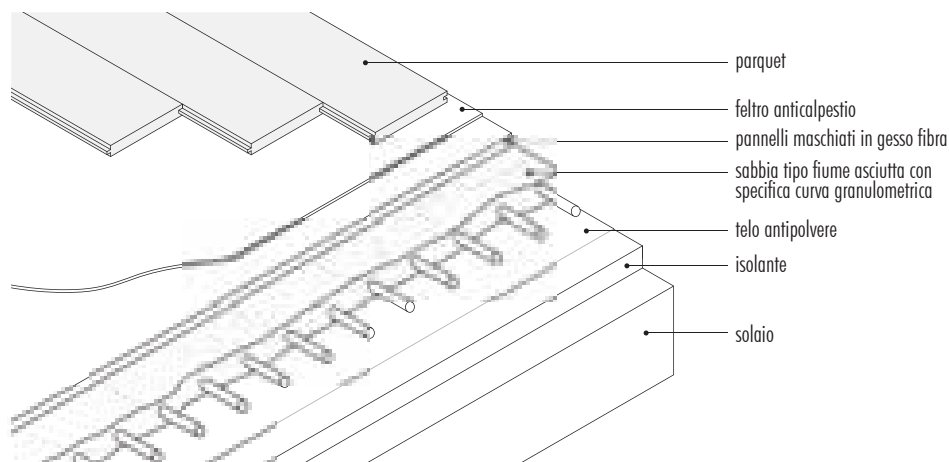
\_Pavimentazione in legno su massetto radiante a secco, in sabbia.
